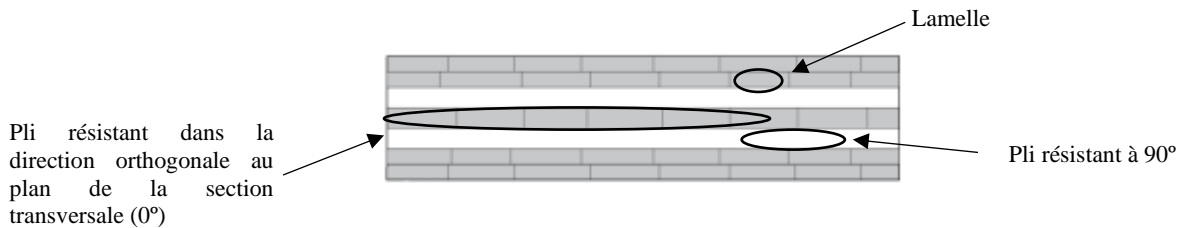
Section d'un panneau CLT 240 L7s-2.
